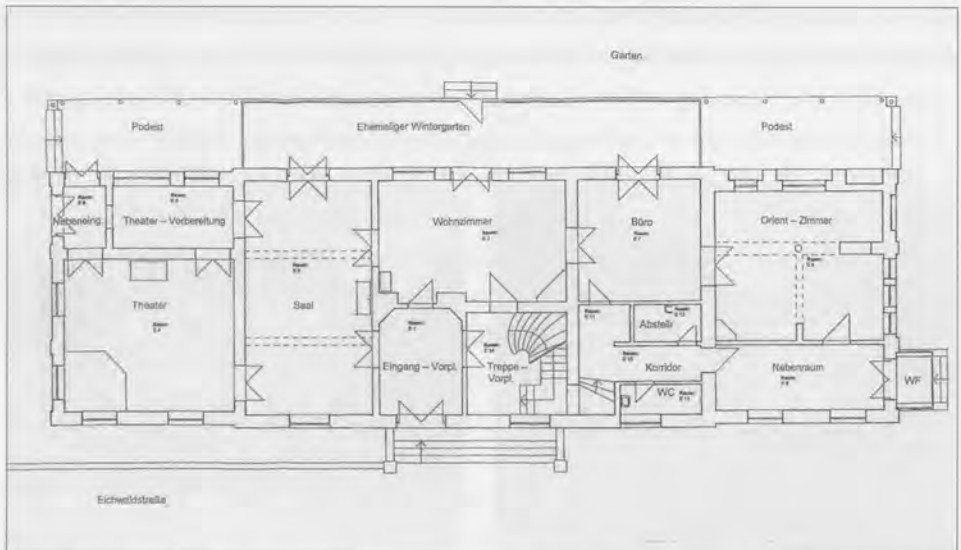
Villa Leuchtenberg, Grundriss des Erdgeschosses (gegenüber dem Originalzustand leicht verändert)
